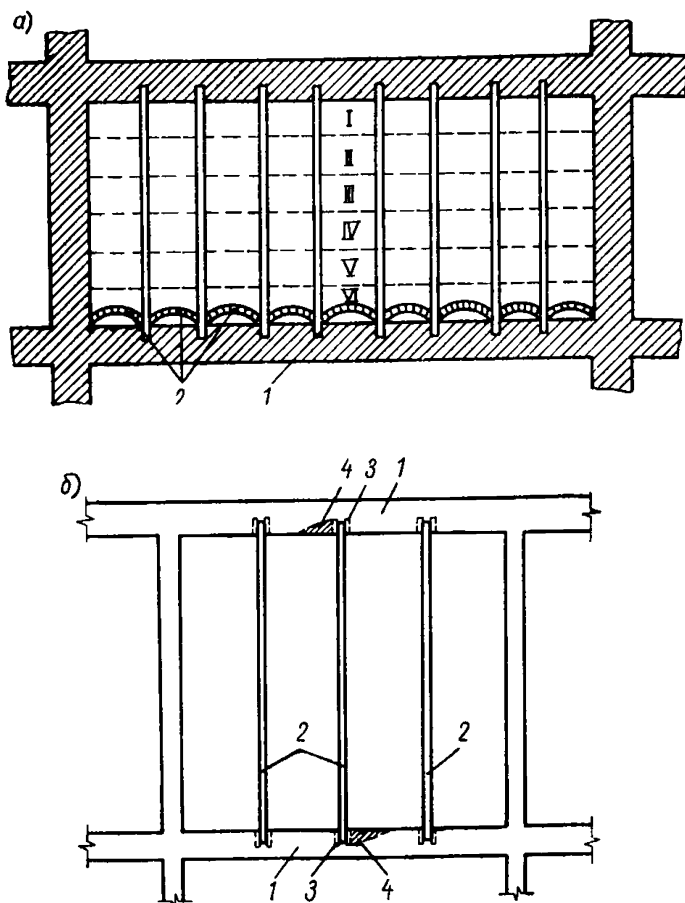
Разборка перекрытий по стальным балкам с бетонными или кирпичными сводами
